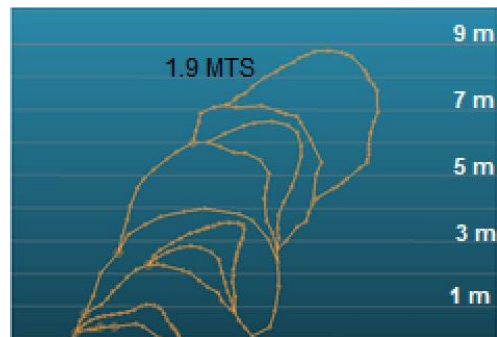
Vista transversal de las alturas de cada corte en Reb. 2200 VUT (geología, 2024)
